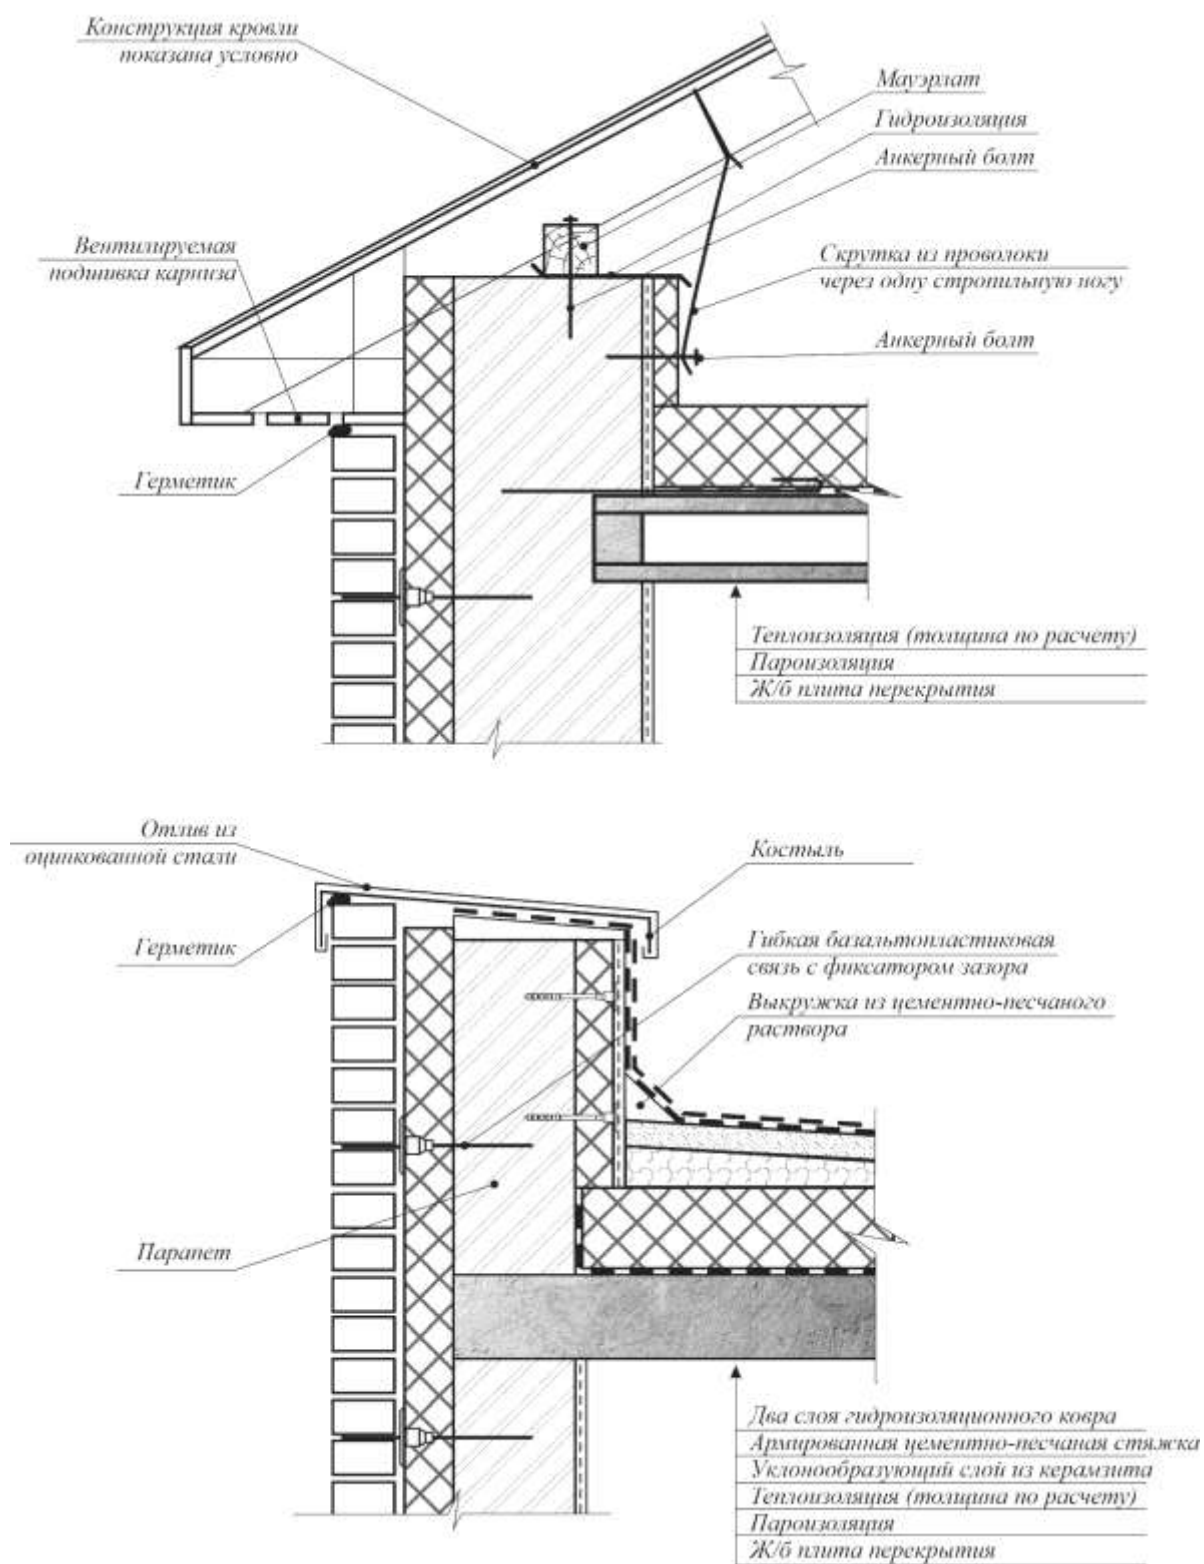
Узлы примыкания наружной стены с трехслойной кладкой к скатной и плоской кровле
